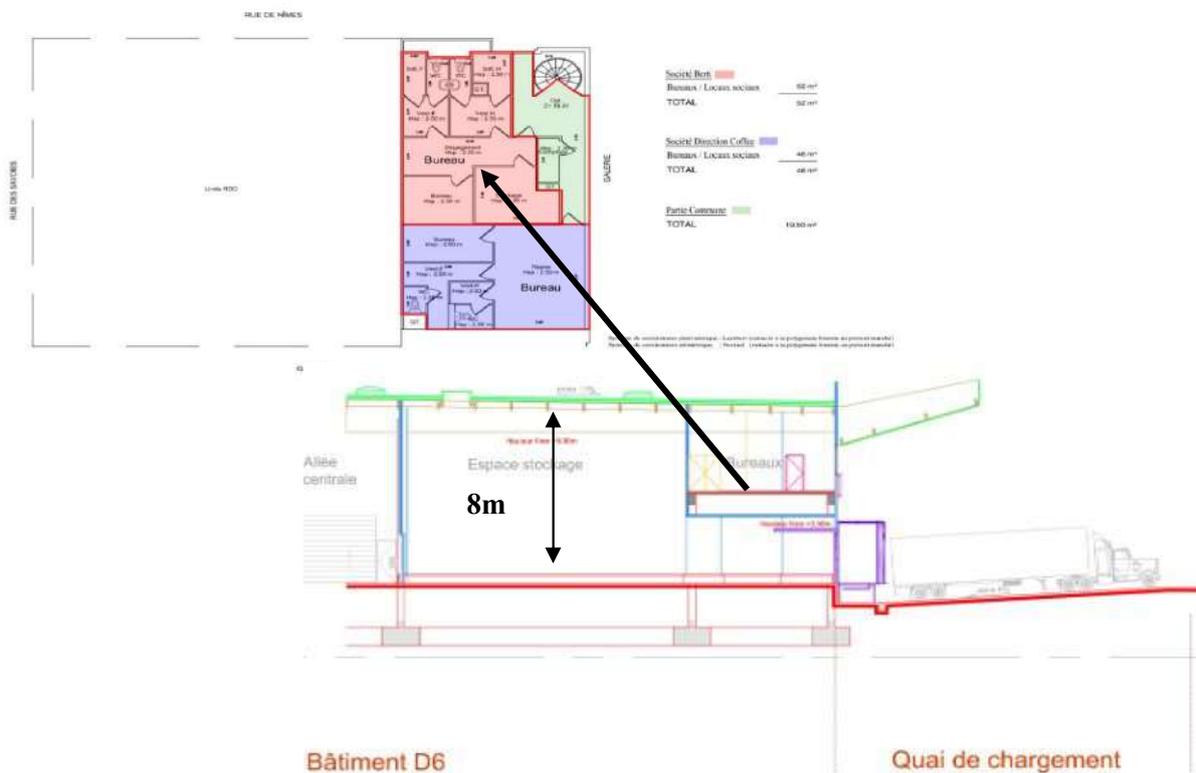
plan des bureaux et coupe qui montre l'espace de stockage
